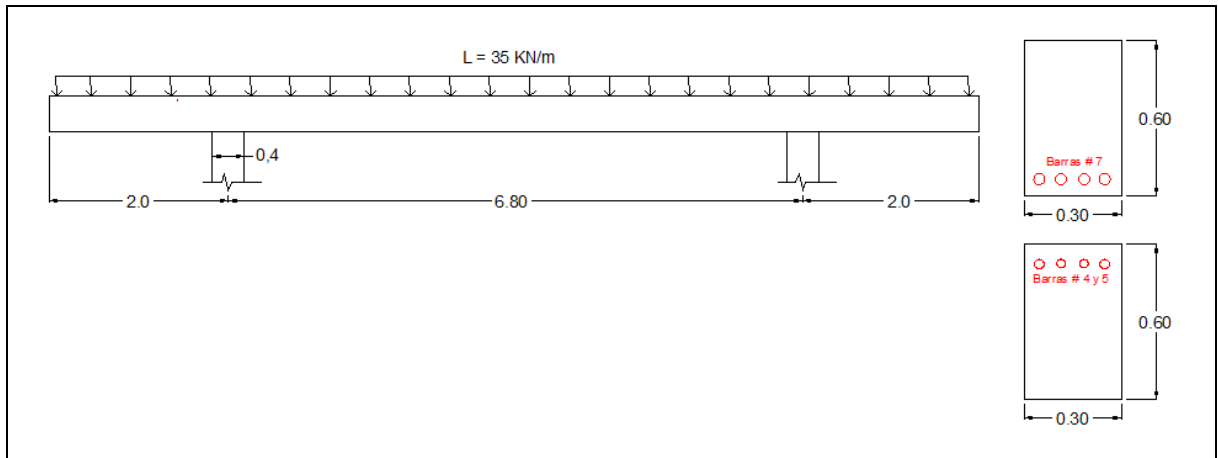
Viga con doble apoyo continuo en voladizo
